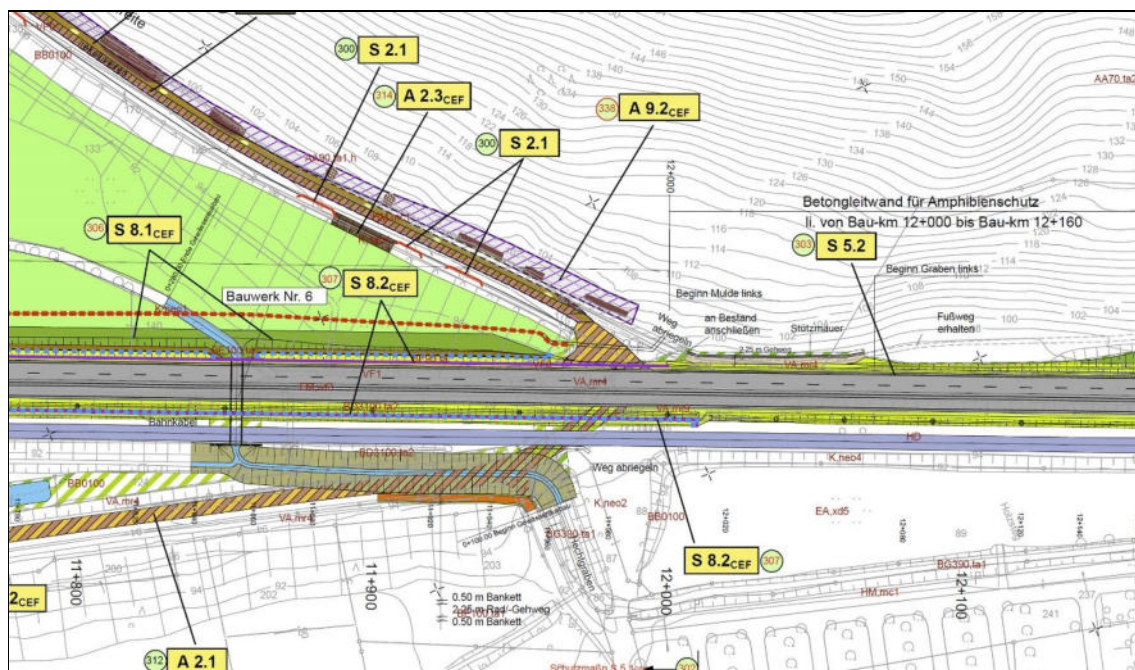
Ausschnitt aus dem Maßnahmenlageplan des LBP zu FR 1 + FR2.
